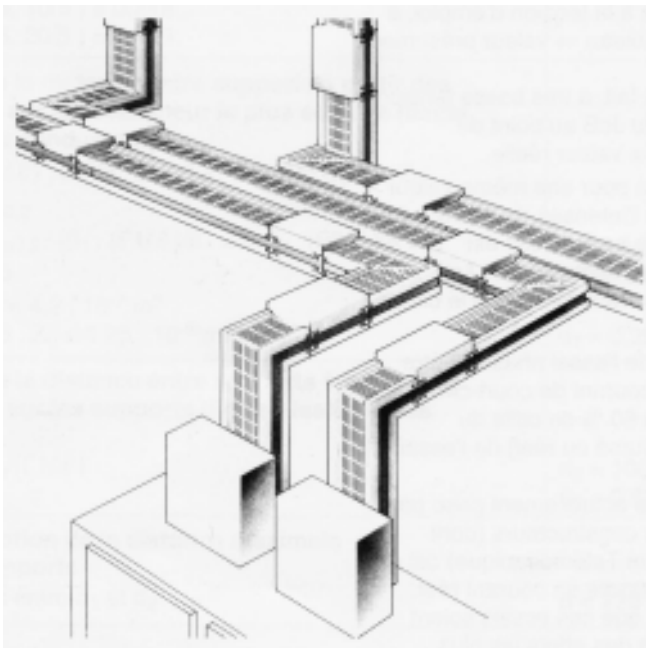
JdB prefabricado de distribución eléctrica 3000 A Canalis (Telemecanique).
